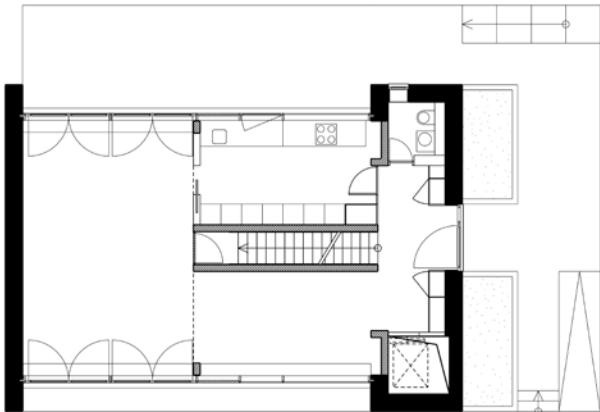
Einfamilienhaus in Berlin, Grundriss EG
